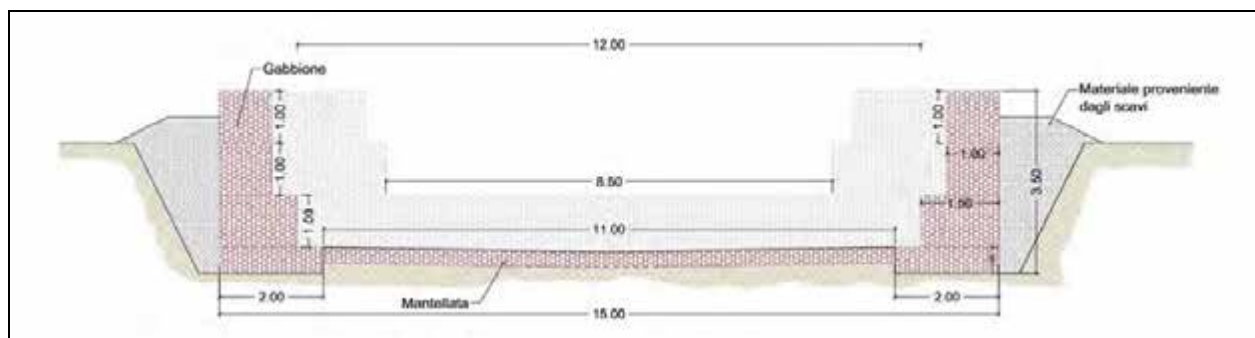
Sezione tipo (da sez. 5.4 a sez. 5.3)
